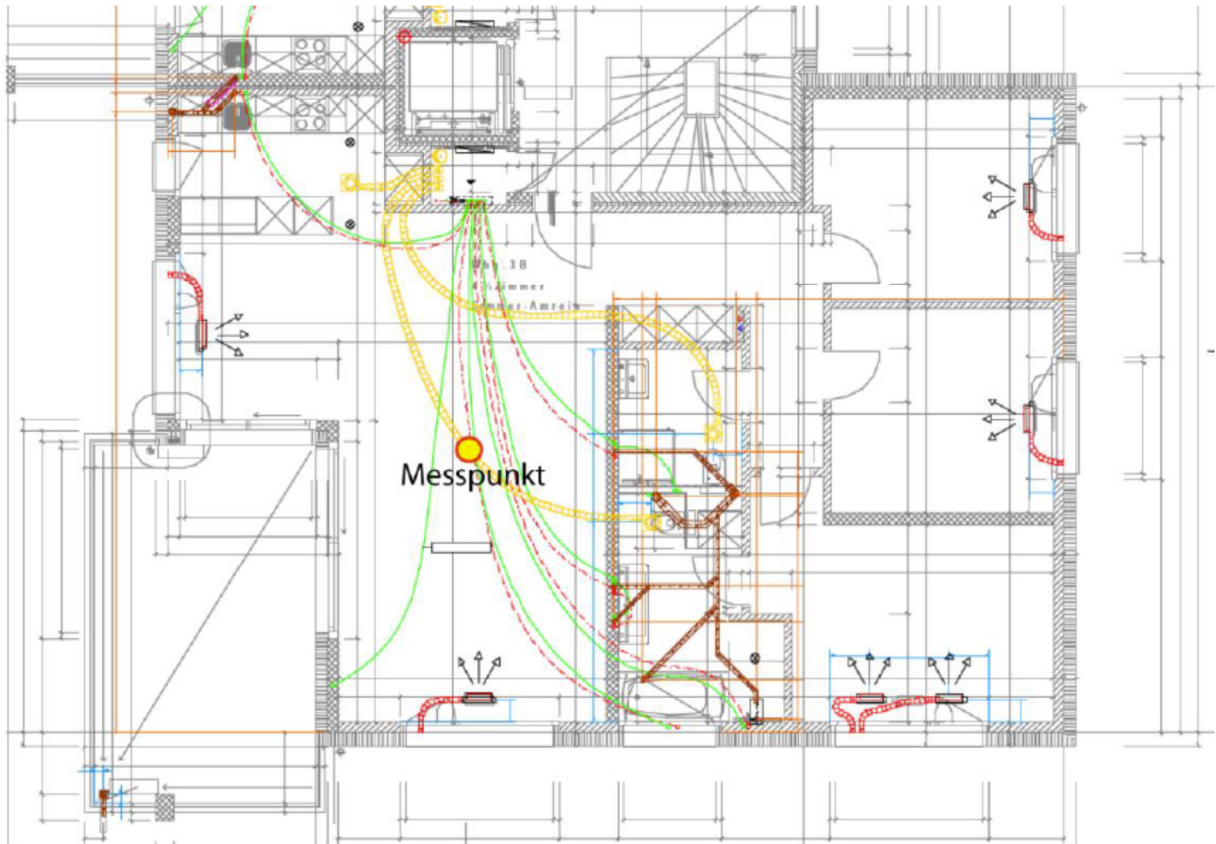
Grundriss 4.5Zi-Wohnung in Malters mit Messpunkt VOC
